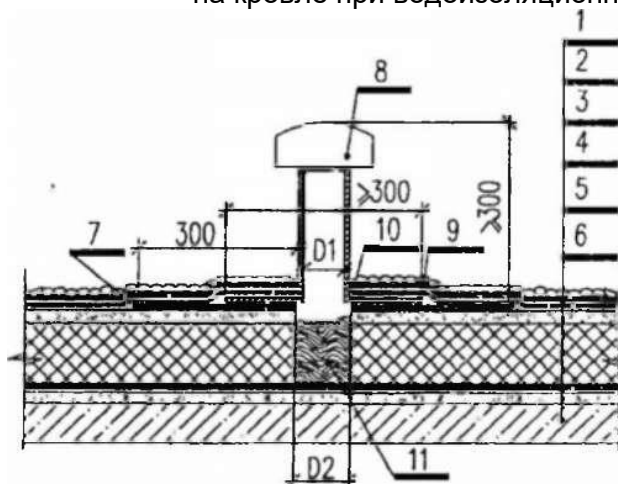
Установка аэратора на кровле при водоизоляционном ковре по стяжке
